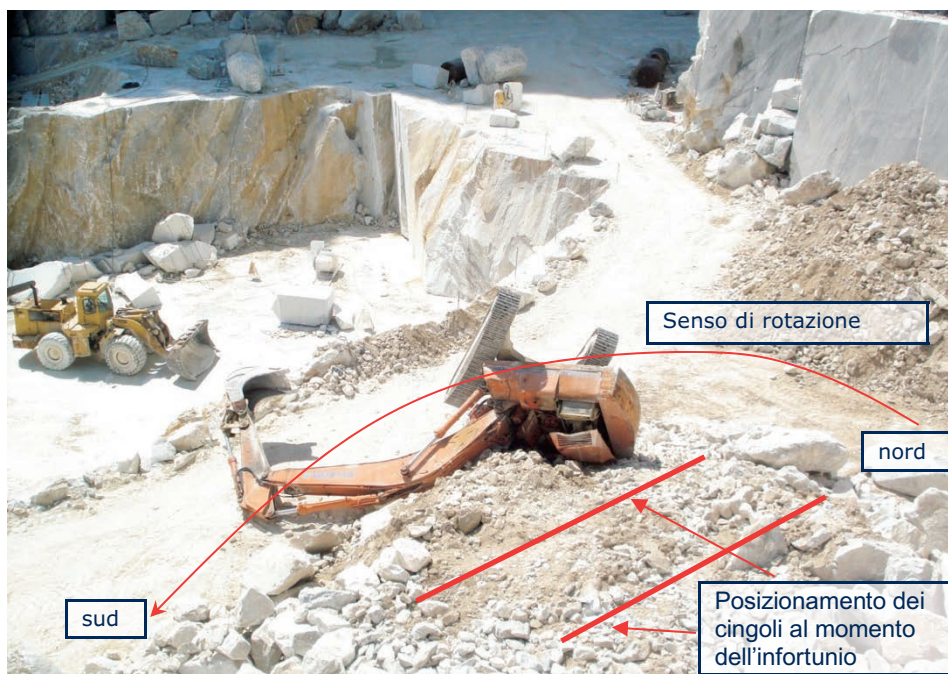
presunta posizione e movimento dell'escavatore prima del ribaltamento
